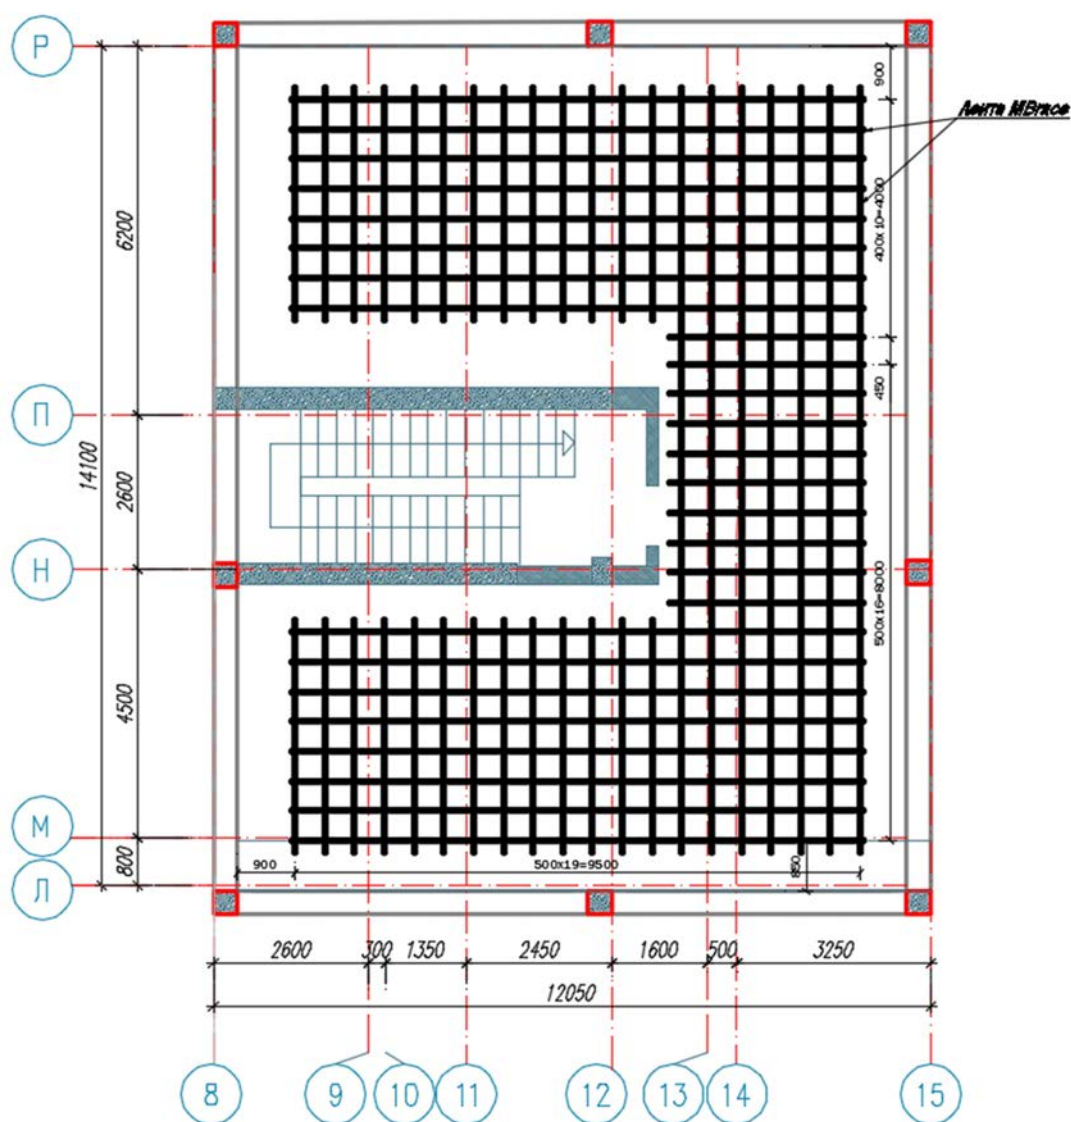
Схема фрагмента усиления плиты на отм. +22,000 Блока «С»
